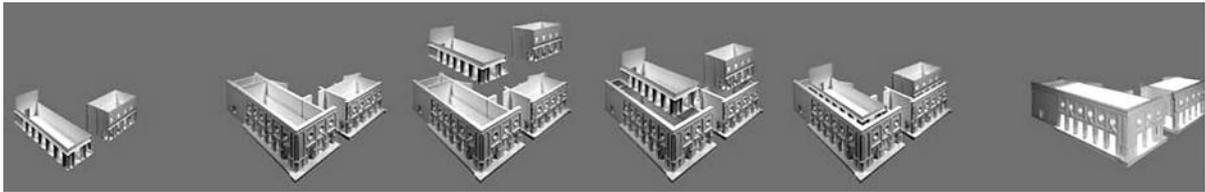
Modelos a escala de la propuesta de intervención arquitectónica del proyecto de adecuación.
